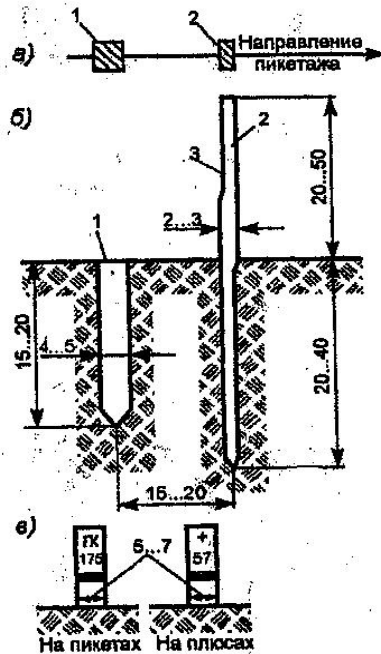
Пикетная (плюсовая) точка и сторожок: а) – план; б) – разрез по трассе; в) – вид сторожка спереди; 1 – точка; 2 – сторожок; 3 – место затёски.
